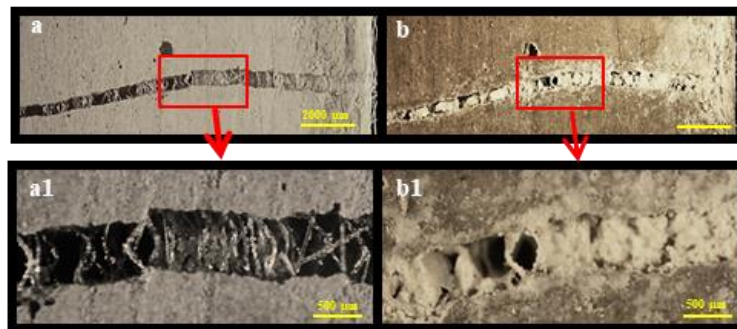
Imagem das fissuras: a- após pré-fissuração; b- 7 dias.
